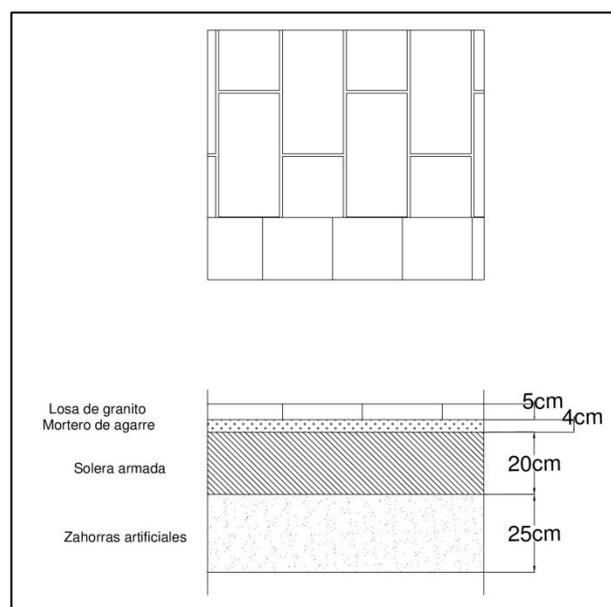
Sección tipo 2 pavimento endosado granito
